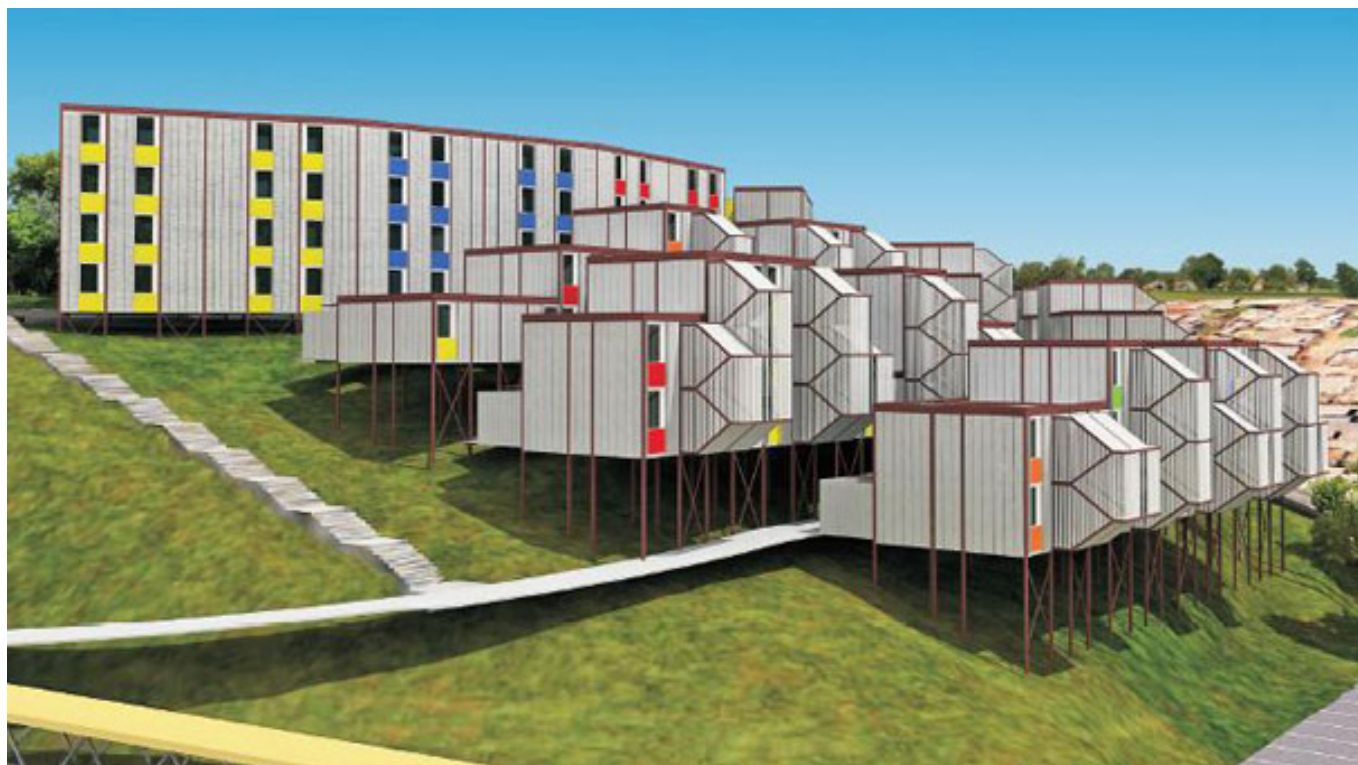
Terceira Etapa: finalização da montagem. Há a instalação dos fechamentos das habitações pelo posicionamento junto à estrutura dos painéis de argamassa armada.
